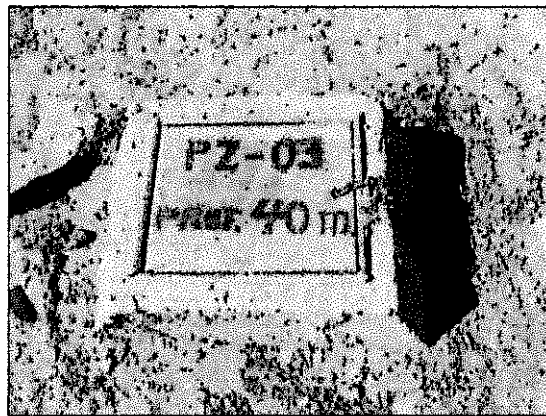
Instalación de Piezómetro PZ - 03, ubicado de la parte baja de las Pozas PLS-ILS.
